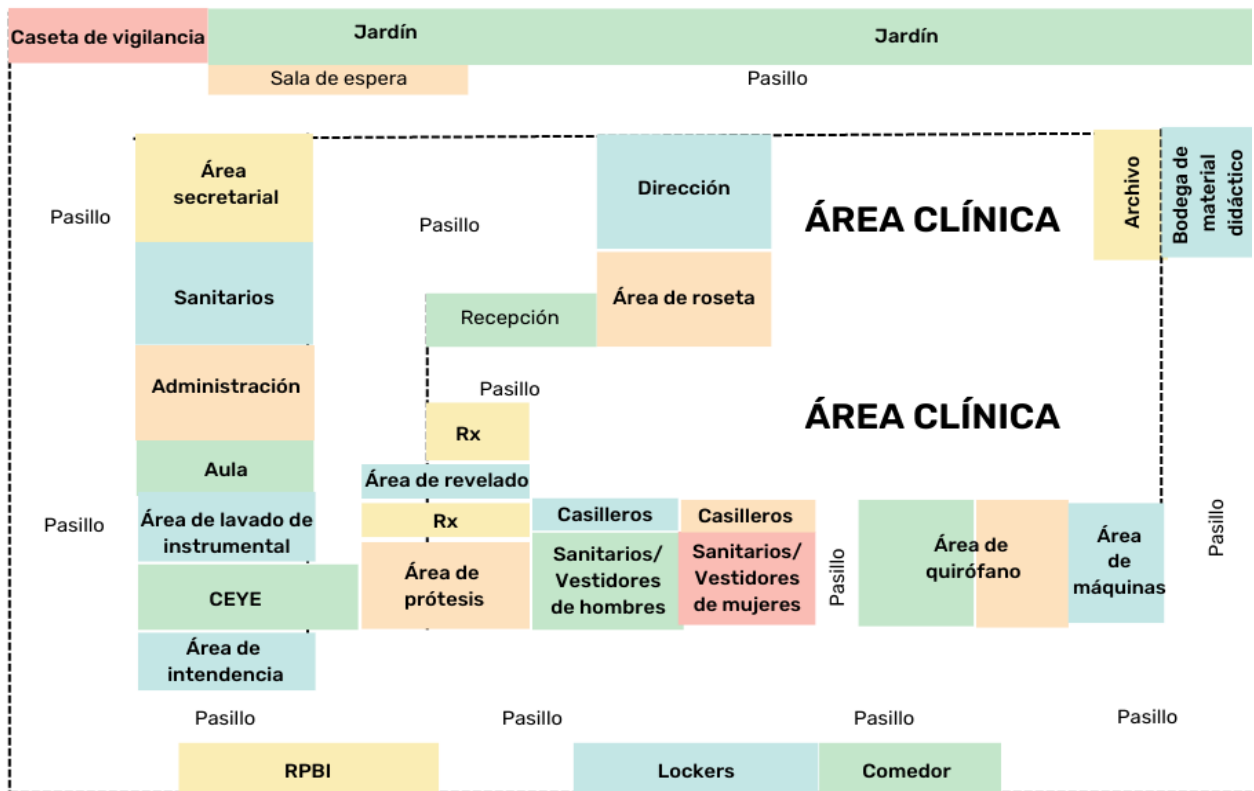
3 Plano arquitectónico actualizado del LDC Tláhuac
